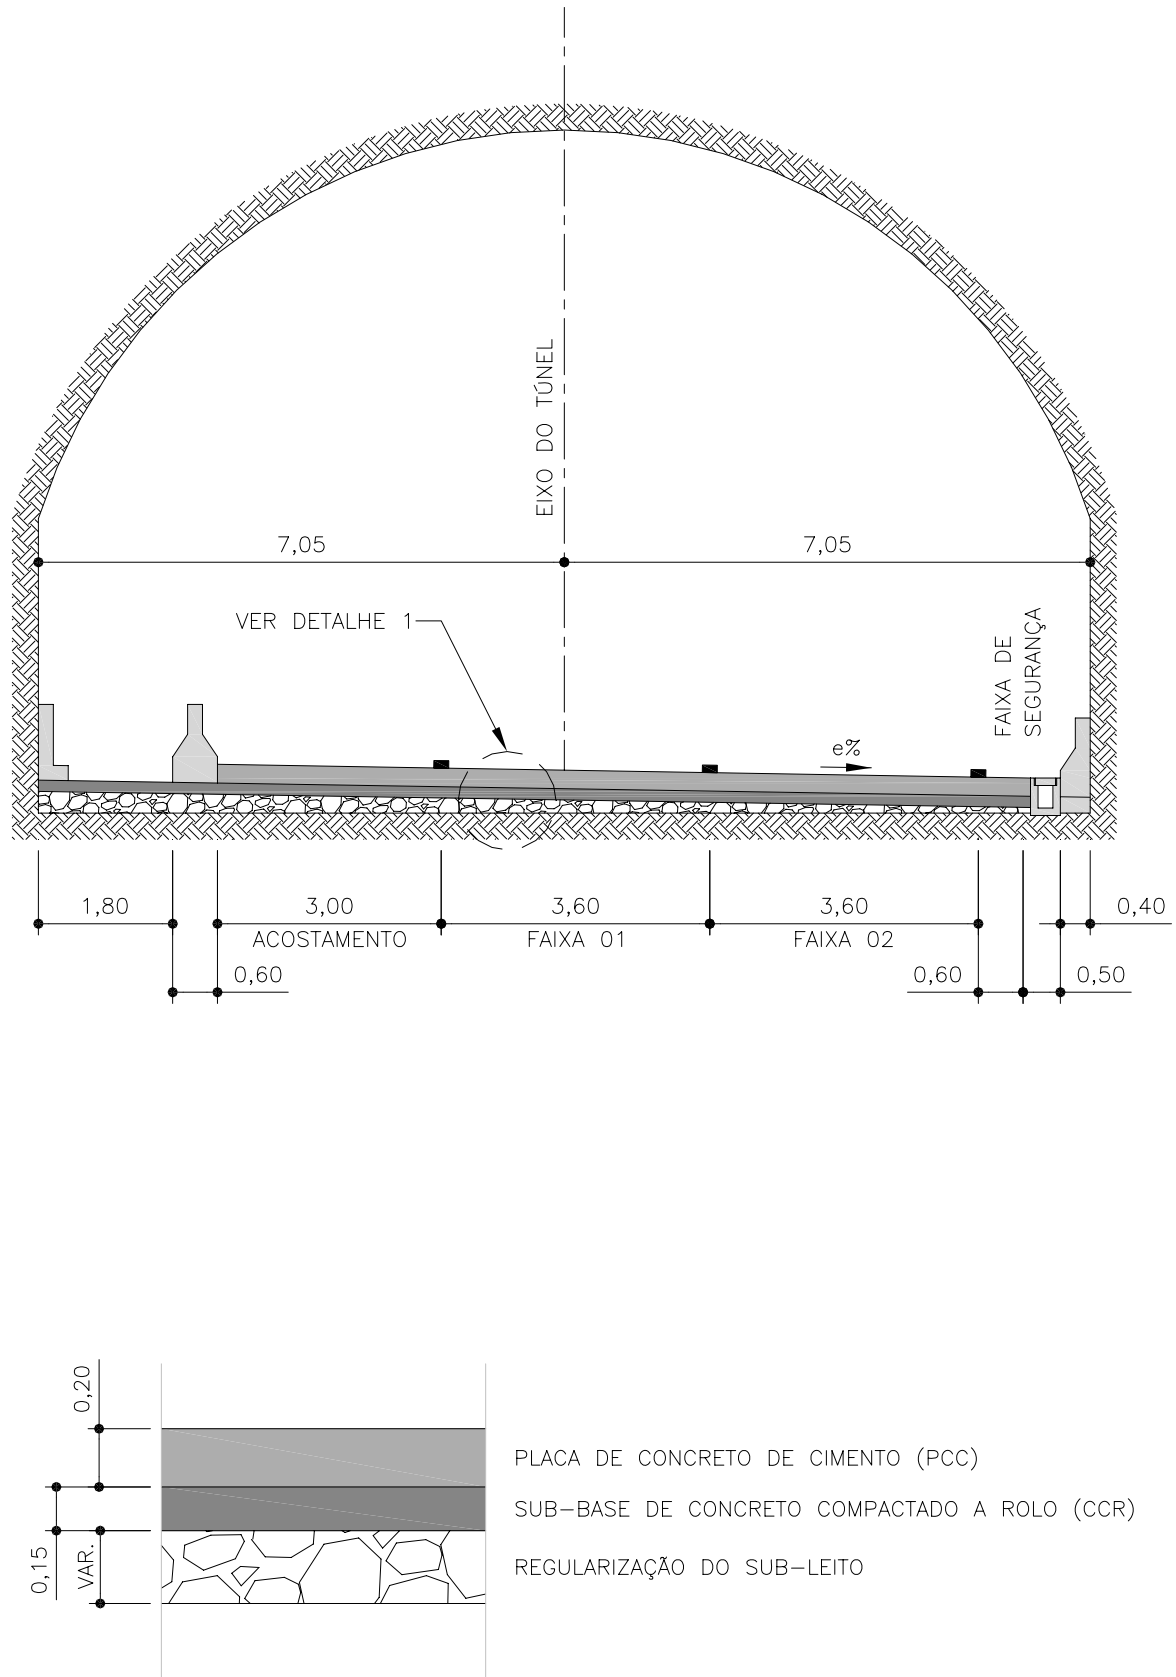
Pavimentação para pista a ser implantada no Lote 2
